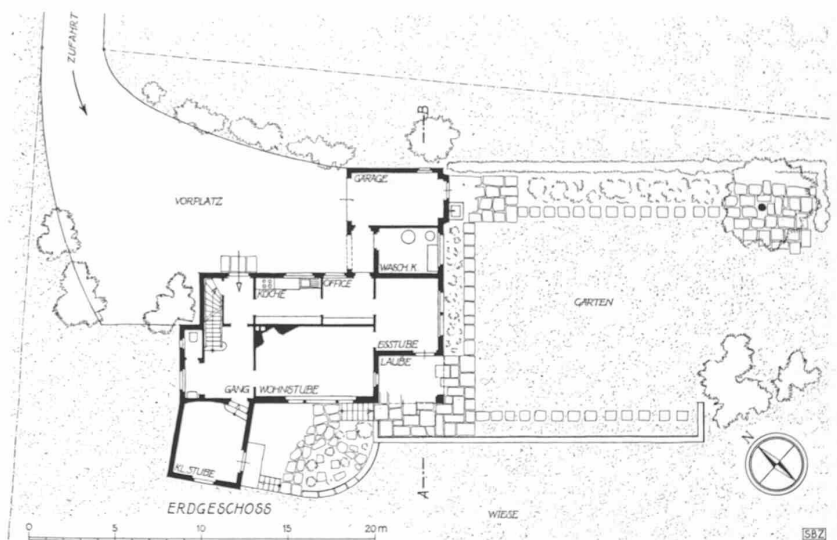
Grundriss von Haus und Garten. — Masstab 1 : 400
